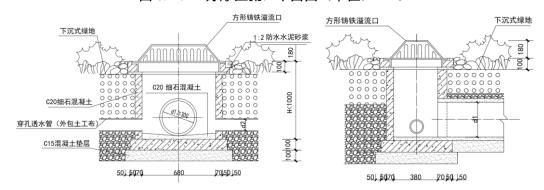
A-A 剖面图 (单位: mm) 图 6.11.1-3 B-B 剖面图 (单位: mm)
